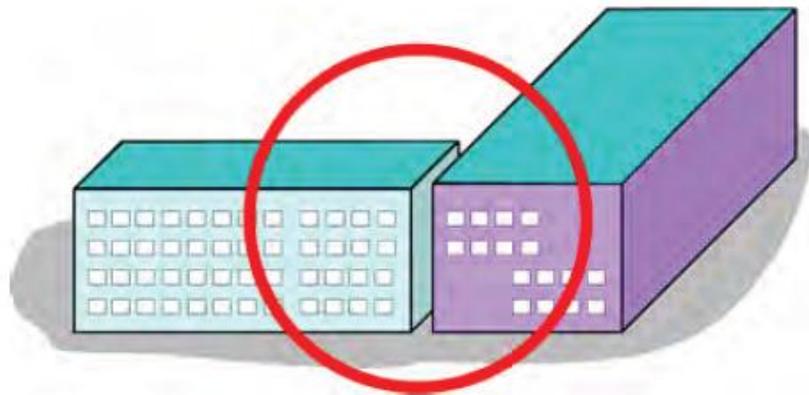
Las juntas de expansión ayudan a simplificar los edificios en planta (fuente: Murty 2005).
